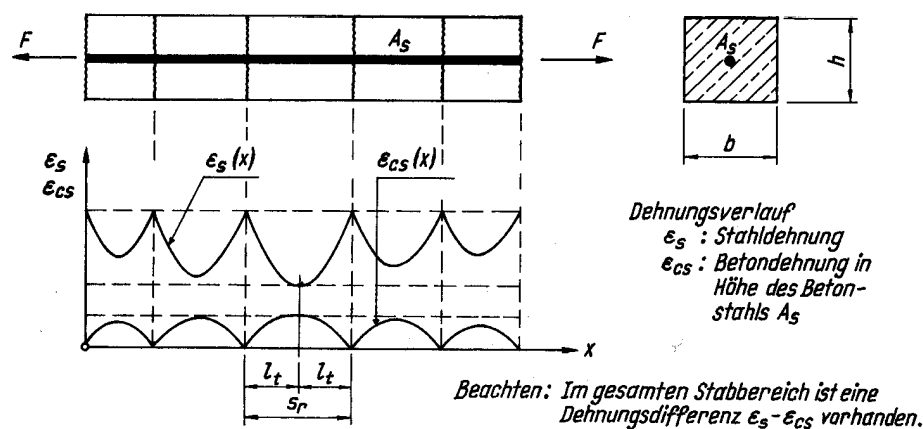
Abgeschlossene Rissbildung bei einem zentrisch gezogenen Stahlbetonstab
